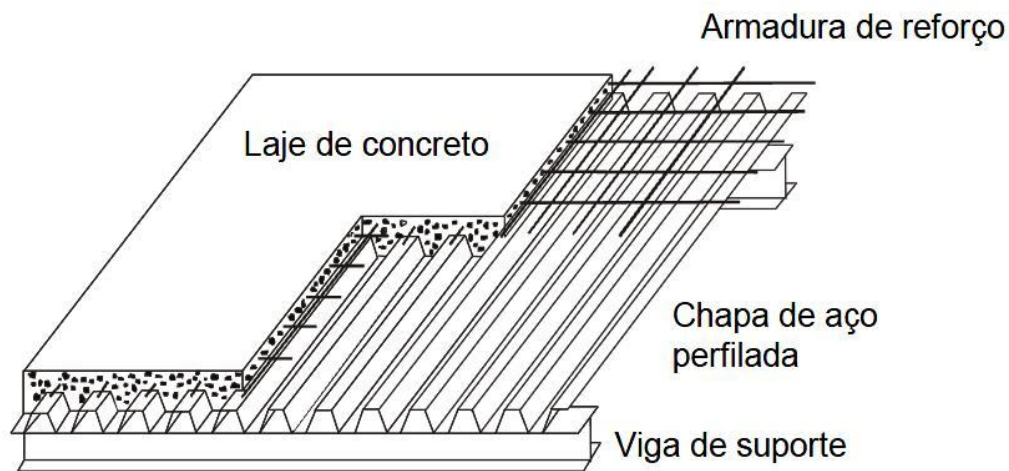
Laje mista aço-concreto (SAÚDE *et al.*, 2005)
